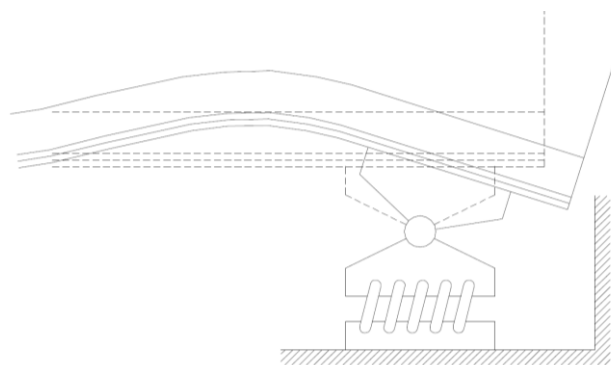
Aparelho de apoio bloqueado (adaptado de [34])
